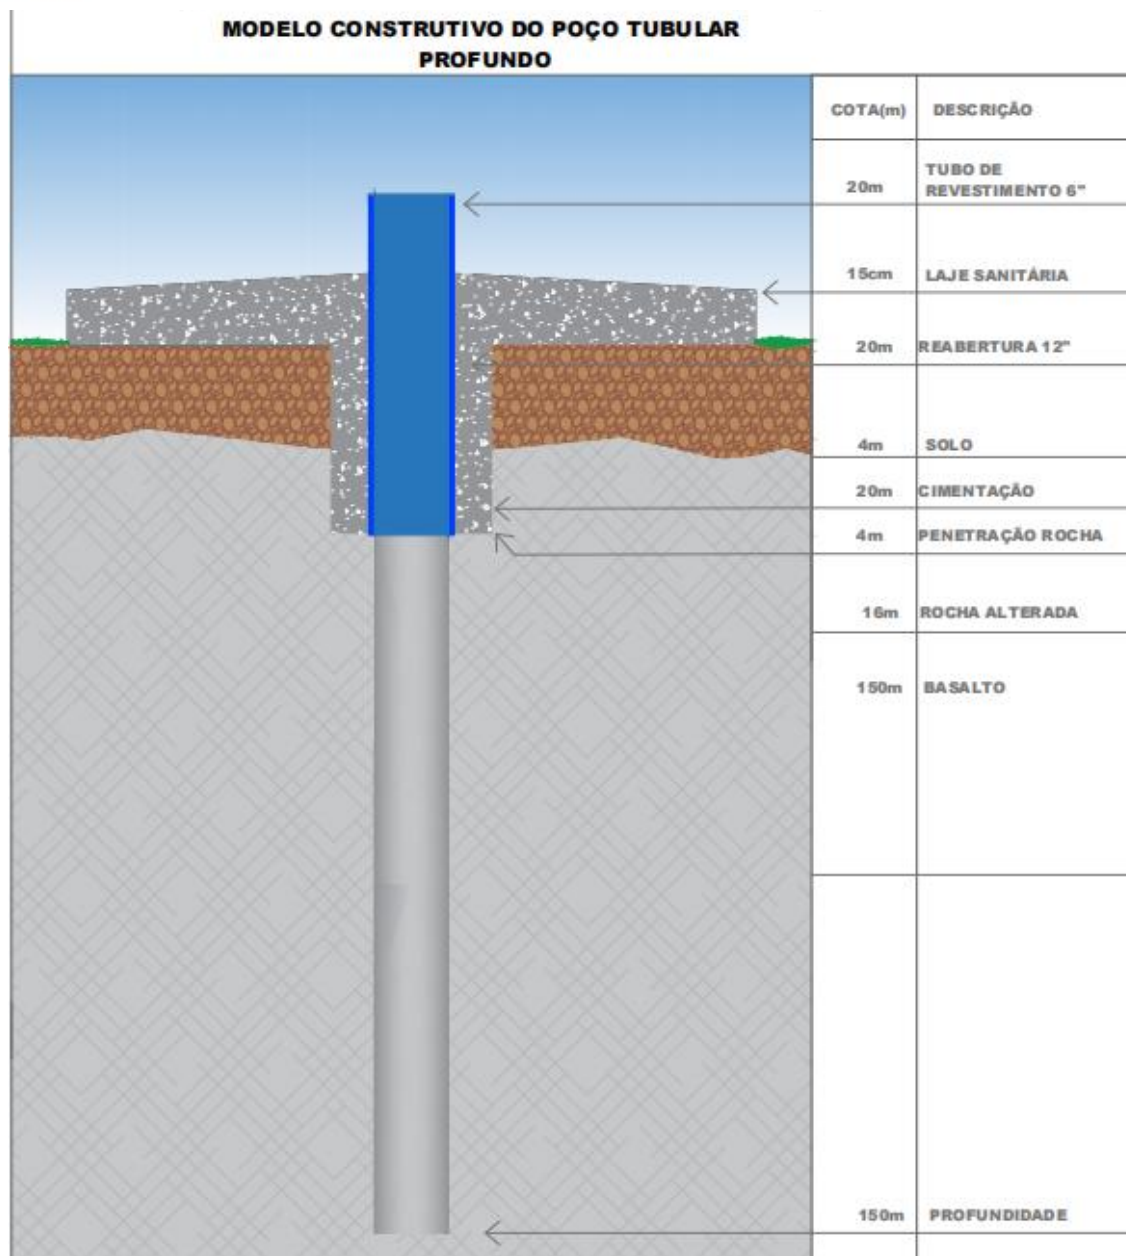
Perfil construtivo preliminar para o poço tubular projetado.
